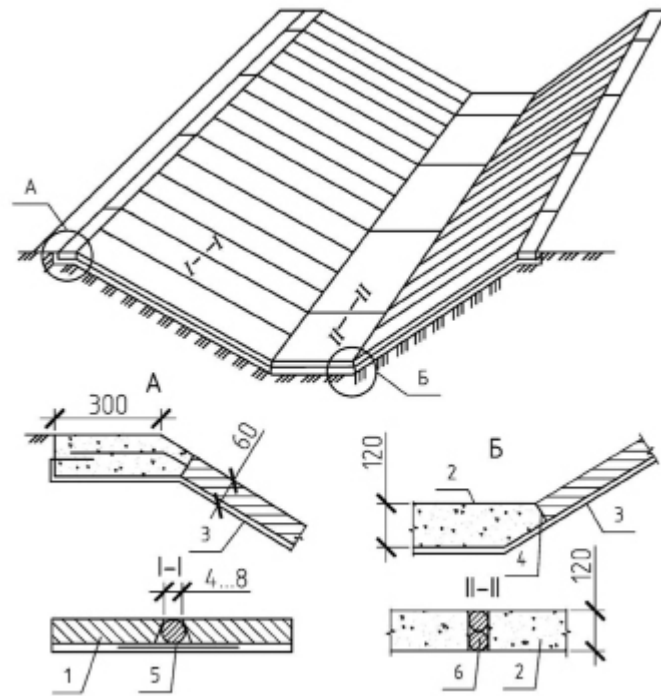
Розкладка збірних залізобетонних плит на укосах каналу:
